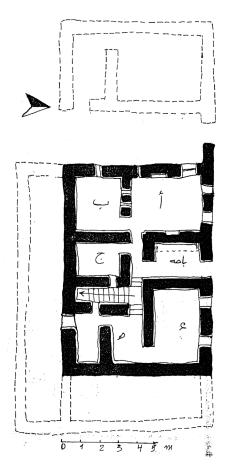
منزل الشريف عبد المطلب الدور الأرضى - مسقط افقى
